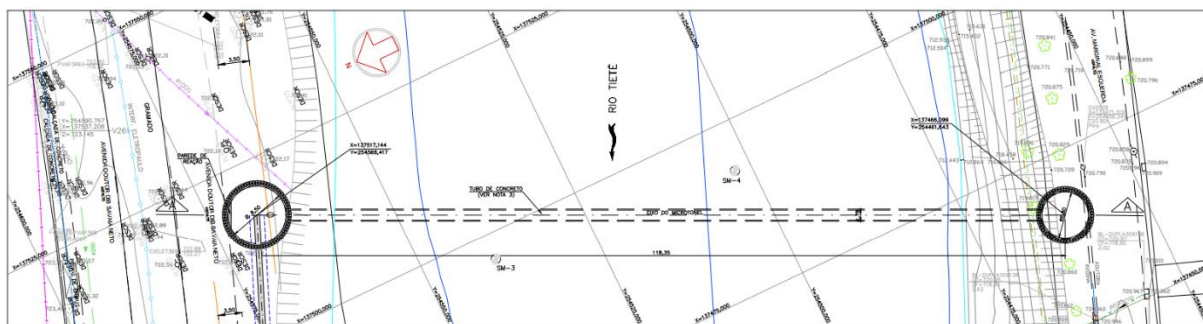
Planta da travessia com a indicação dos poços, no lado direito o bairro de Barueri e no lado esquerdo Alphaville. (Fonte: Projeto Executivo GeoCompany)
